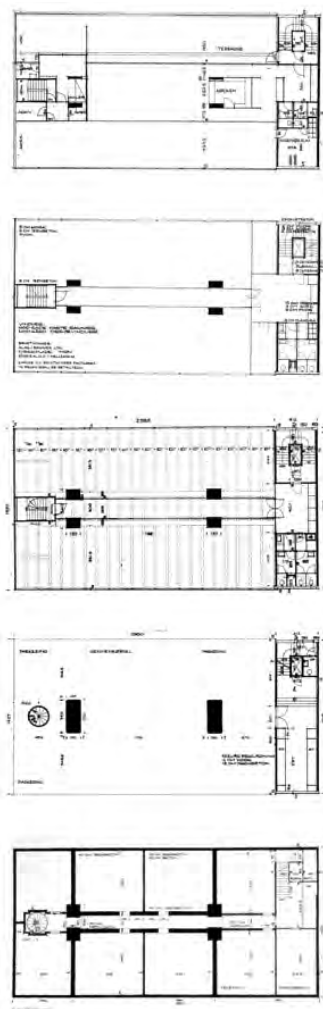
Arne Jacobsen. Edificio Jespersen. Planta baja de la manzana. (Revista PAB 04-Plantas Bajas. ETSAB/UPC).
